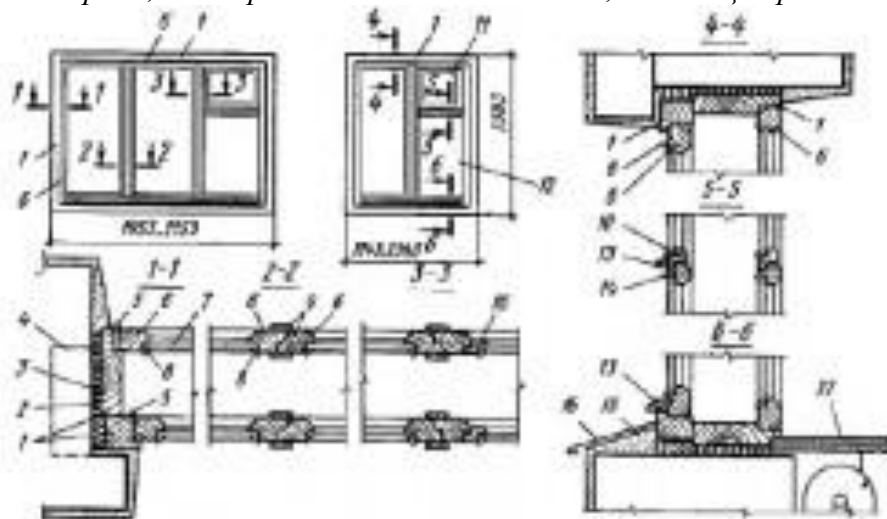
Конструкции оконного блока с цельной коробкой: 1 — коробка, 2 — просмоленная пакля, 3 — гвоздь, 4 — деревянная пробка, 5 — петля, 6 — обвязка переплета, 7 — стекло, 8 — раскладка, 9 — штапик, 10 — обвязка форточка, 11 — форточка, 12 — створка, 13 — отлив, 14 — горбылек, 15 — раствор, 16 — отлив из оцинкованной стали, 17 — подоконник
